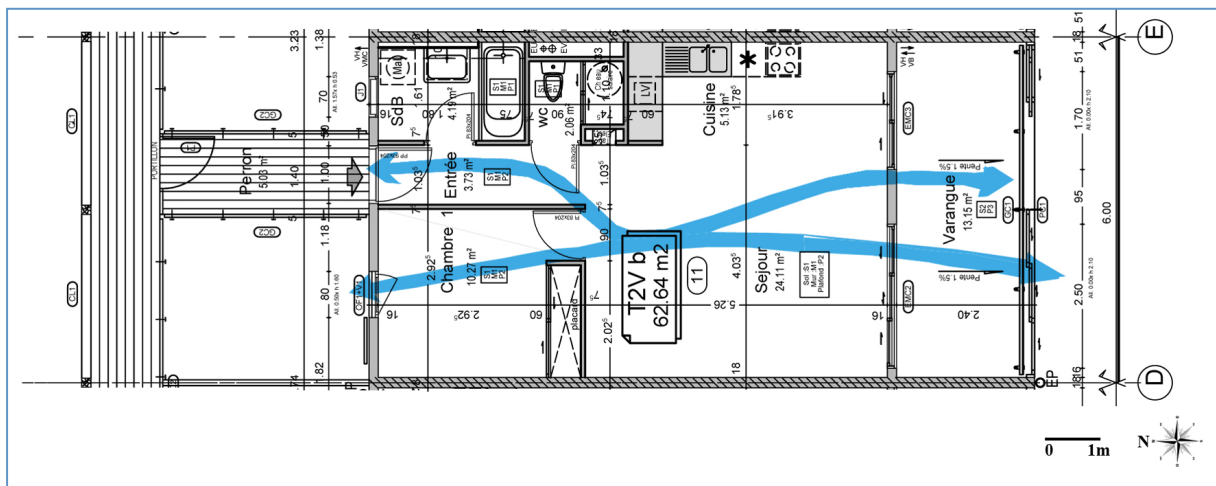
Îlet du Centre, Plan T2Vb, Bâtiment A, Ventilation traversante [Agence 2APMR]
